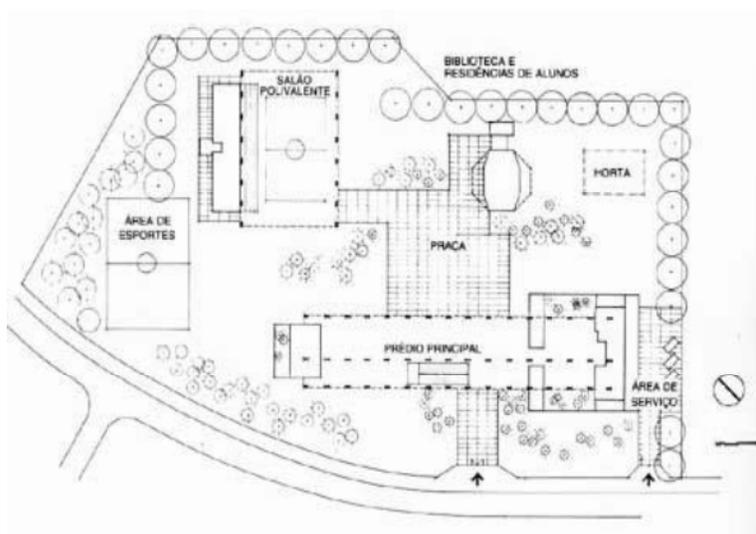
Planta baixa da implantação geral CIEPs (Planta modelo)
